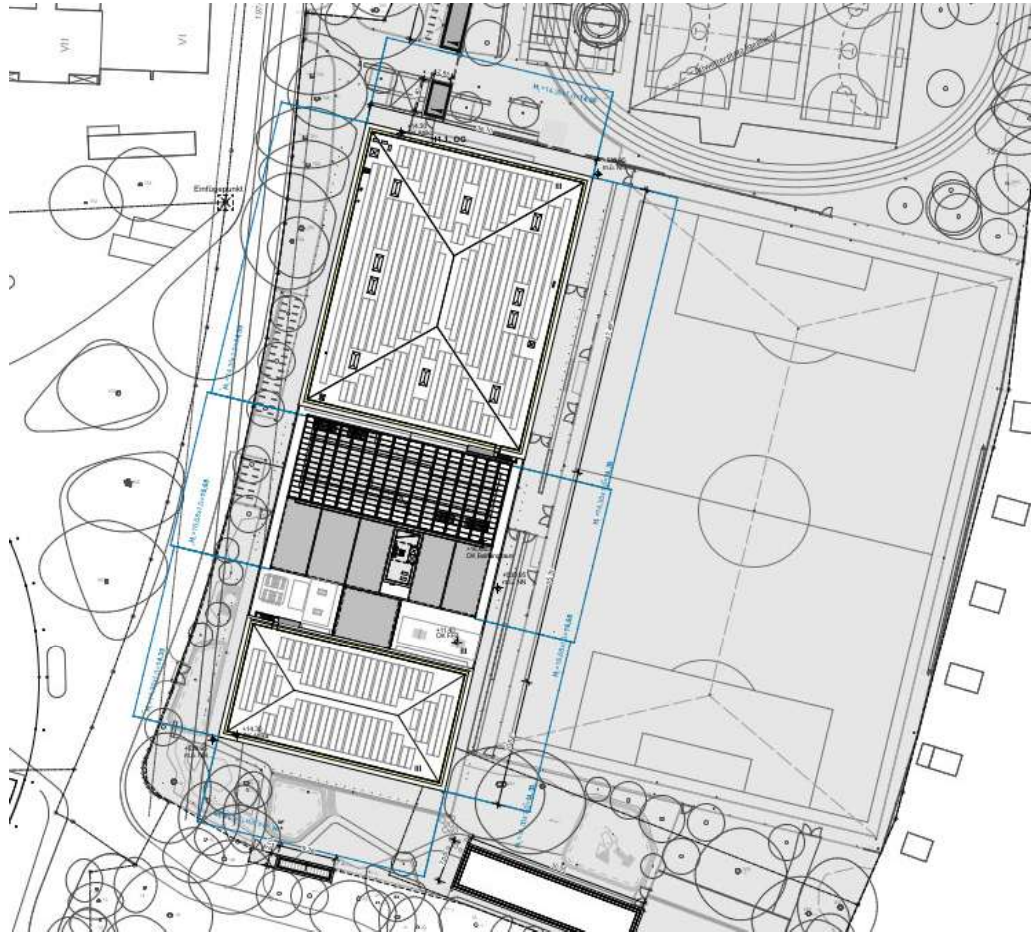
Sportcampus, Lageplan (Quelle: [redacted])
